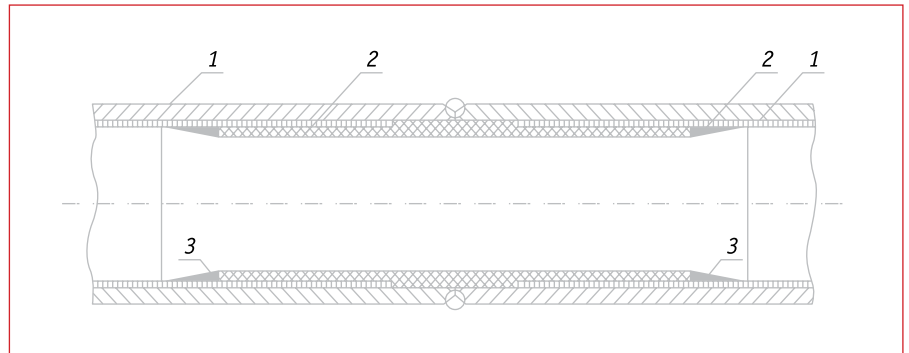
Внутренняя противокоррозионная изоляция бандажной лентой сварного соединения стальных труб с внутренним эпоксидным покрытием:
